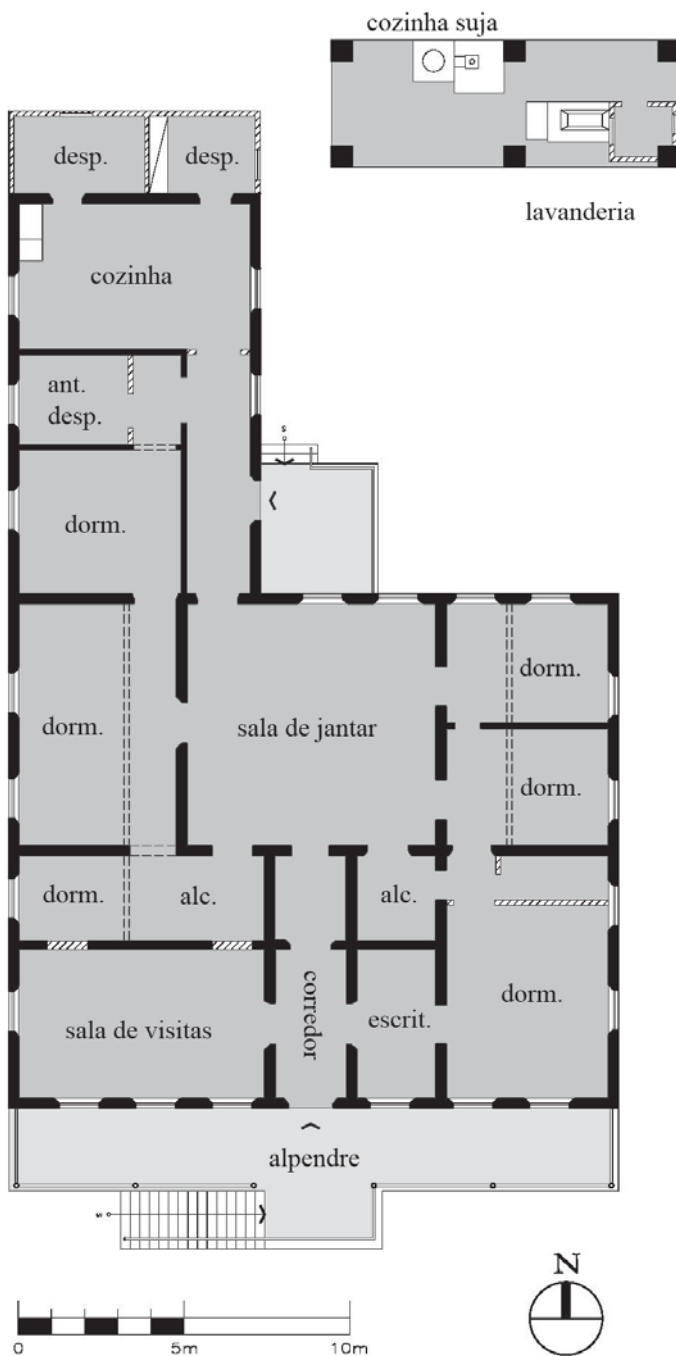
Planta do casarão da fazenda Mandaguahy, Jaú. Lev.: V. Benincasa e M. Rosada. Desenho: V. Benincasa.
